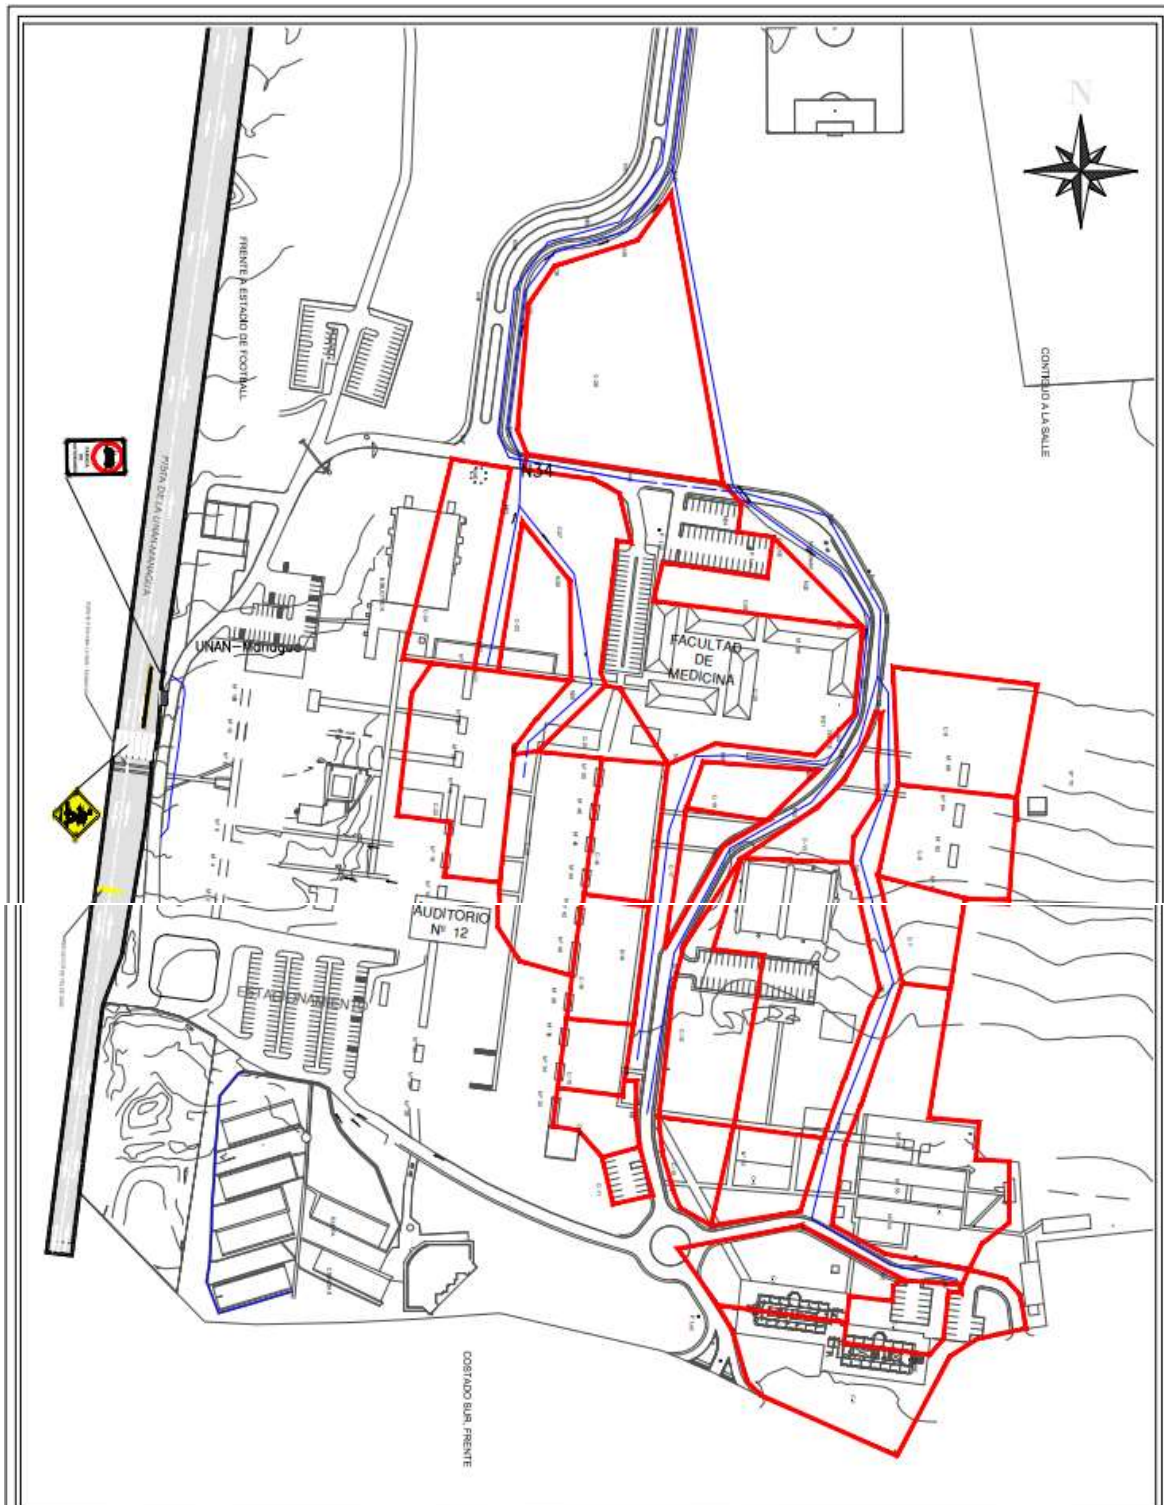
Subcuencas de drenaje para la zona 3
